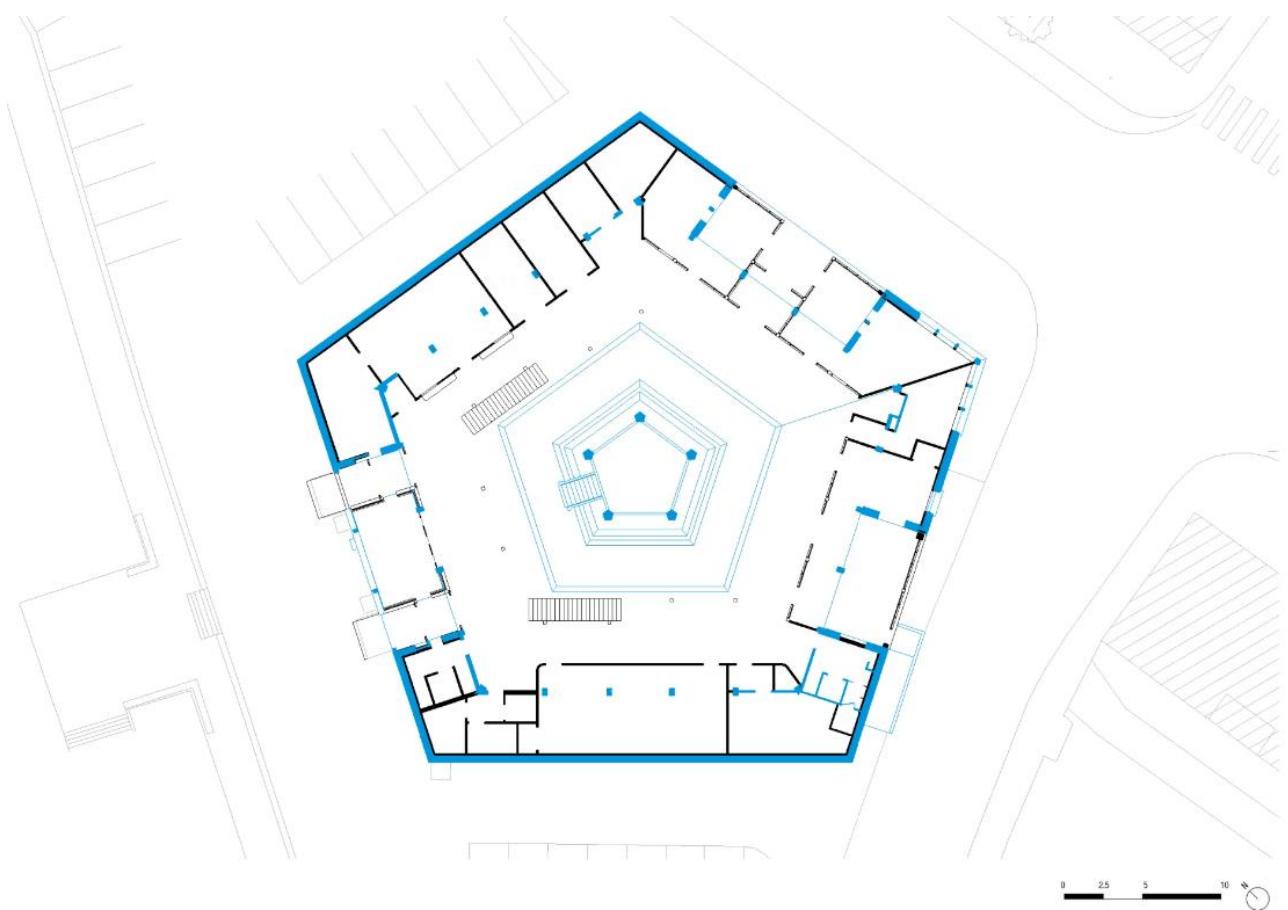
plan du rez-de-chaussée, les éléments en noir sont les éléments à ajouter \_ Encore Heureux Architectes
